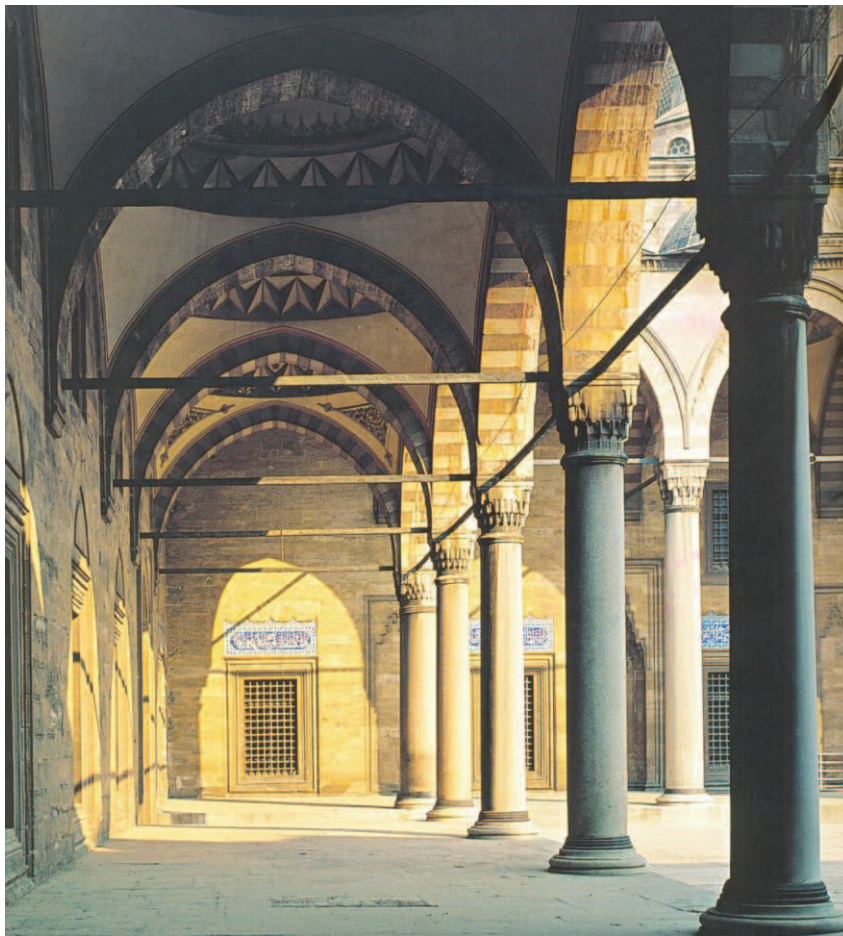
Sistema de atirantamientos para mantener la geometría de un pórtico. (Yerasimos)
